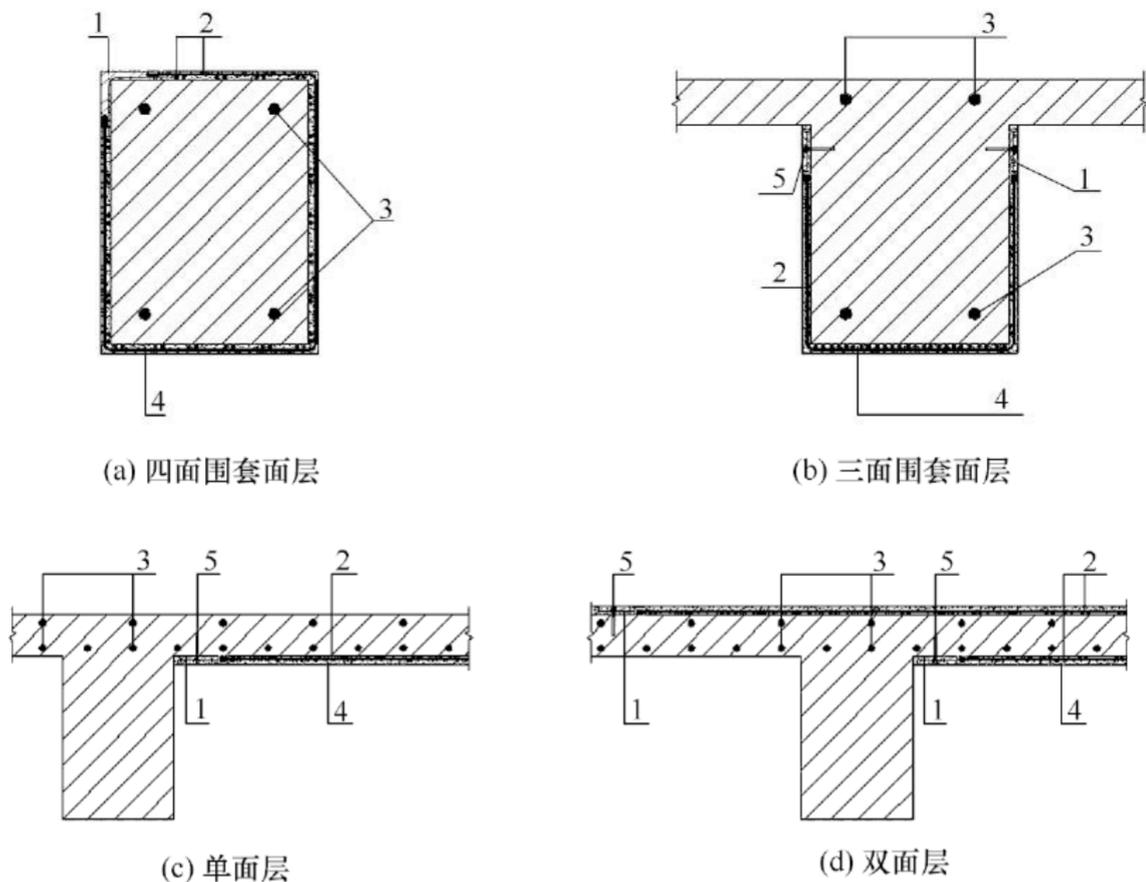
钢丝绳网片-聚合物砂浆面层构造示意图
